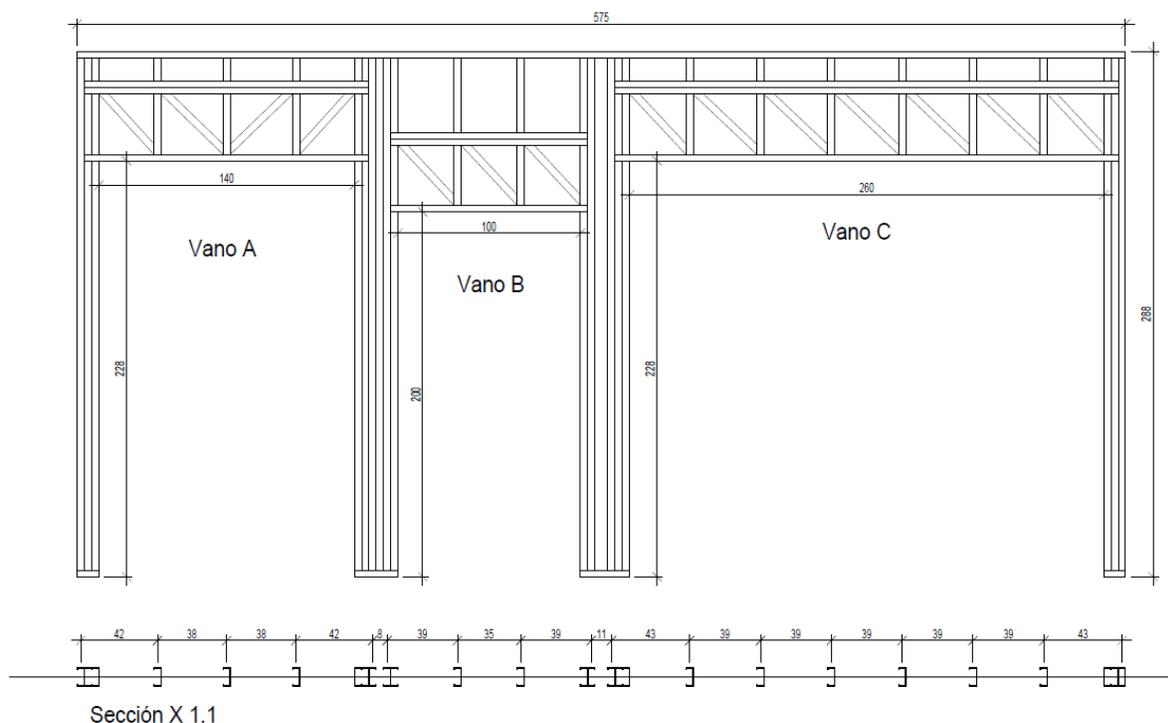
Detalle de la fachada del primer nivel de la vivienda unifamiliar con el sistema Steel Framing. Fuente: Construcciones Steel Framing del Perú.
